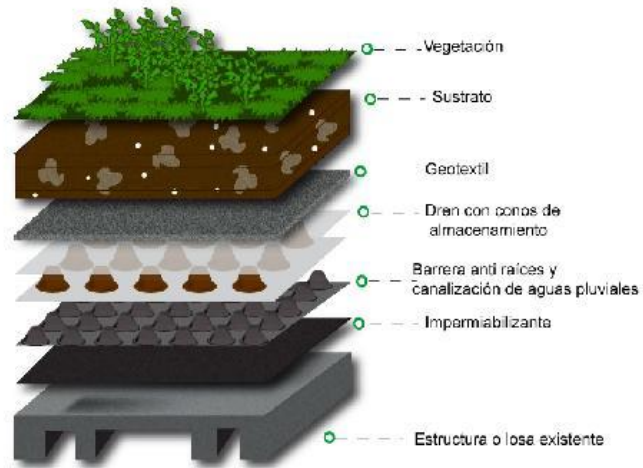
Estructura básica del diseño de roof gardens que se proyectan.
